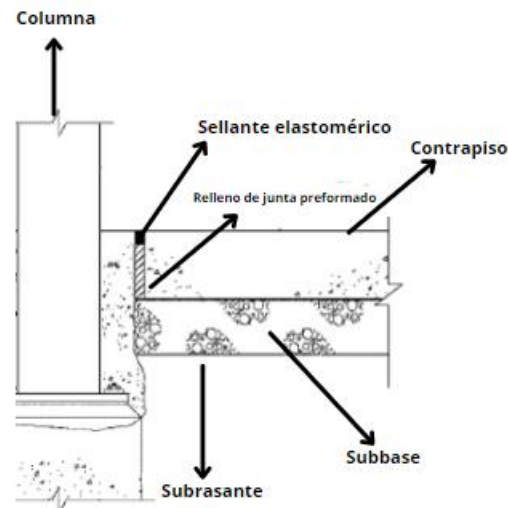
Corte de columna y junta de aislamiento (ACI 360, 2016)
